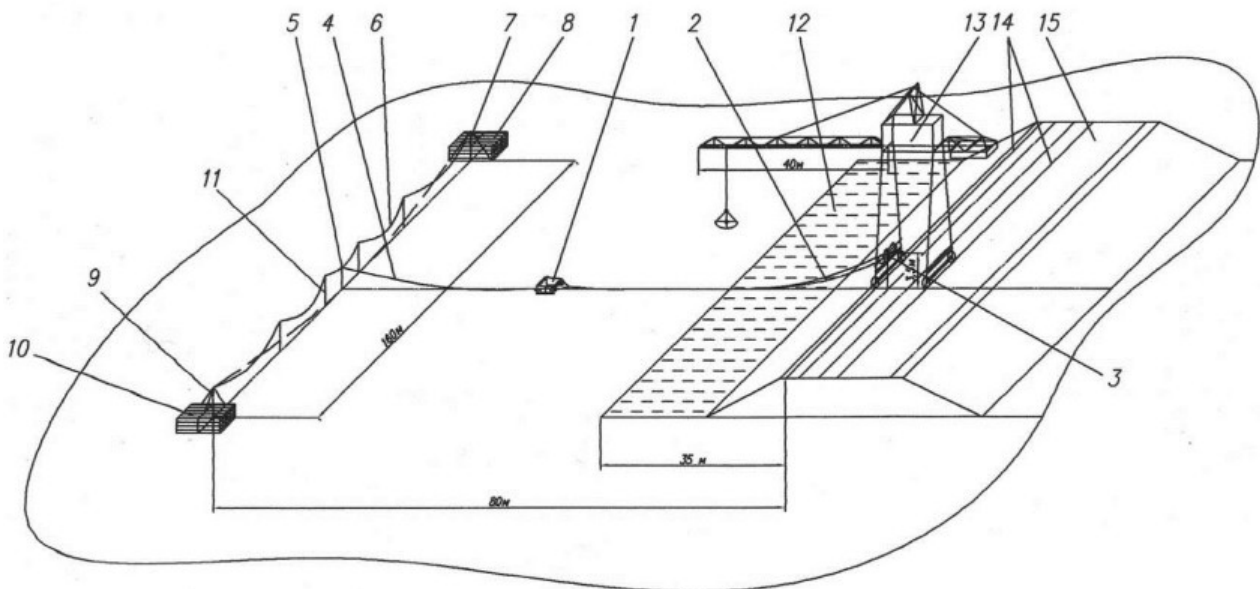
Схема зони забору лікувальної грязі: 1 - скреперний ківш; 2 - тяговий канат; 3 - приводна лебідка; 4 - зворотний канат; 5 - каретка; 6 - несучий канат; 7, 9 - анкерна опора; 8, 10 - баласт; 11 - проміжна опора; 12 - родовище; 13 - рейферний навантажувач; 14 - рейки; 15 - дамба.
